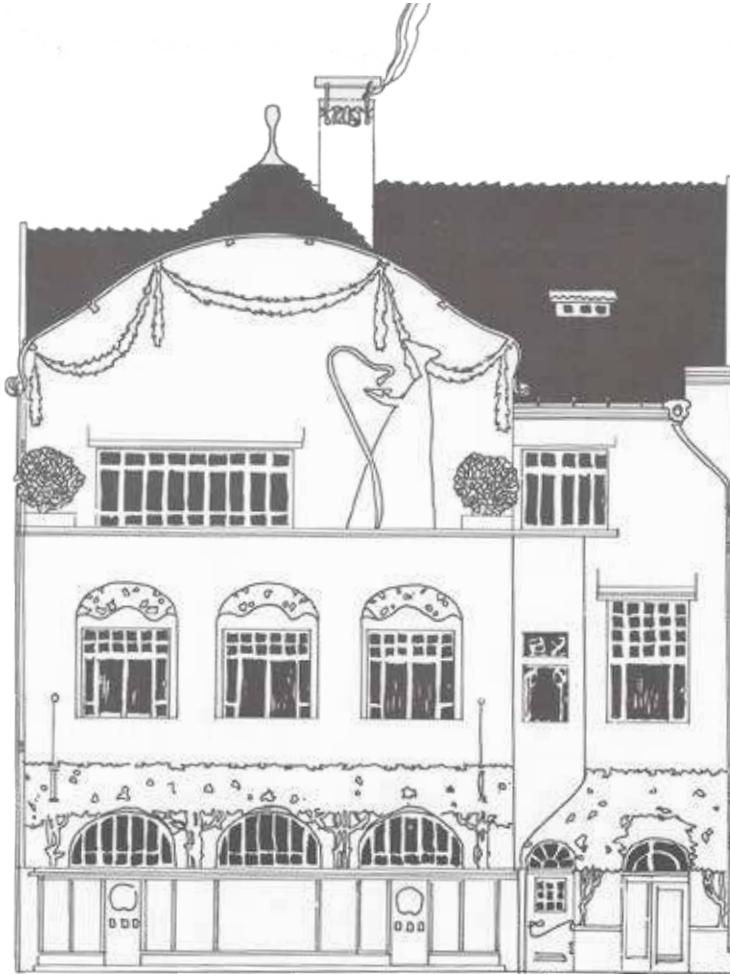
Wohnhaus St.Pölten, Fassade, 1899
